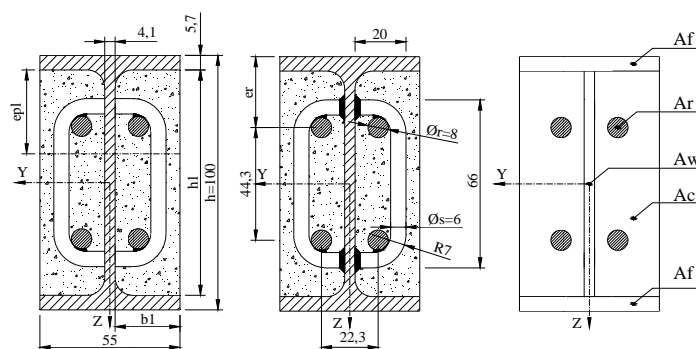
Dimensões da secção recta [mm] e ligações dos estribos.
